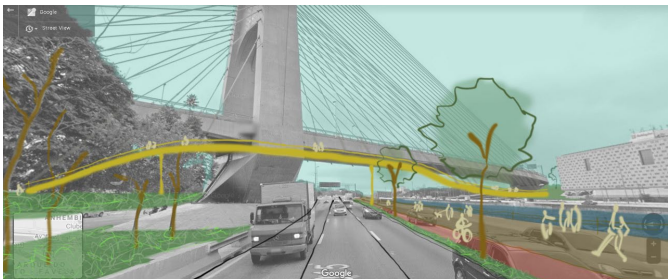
Croqui da proposta transposição de pedestres e ciclistas acima da Marginal Tietê com conexão ao Campo de Marte / Fonte: Autoria do grupo sobre imagem do Google Street View
